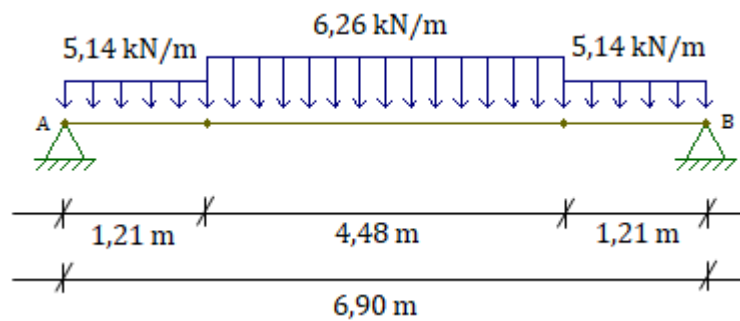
Carregamento aplicado para o cálculo da armadura longitudinal da escada (Fonte: autor).
